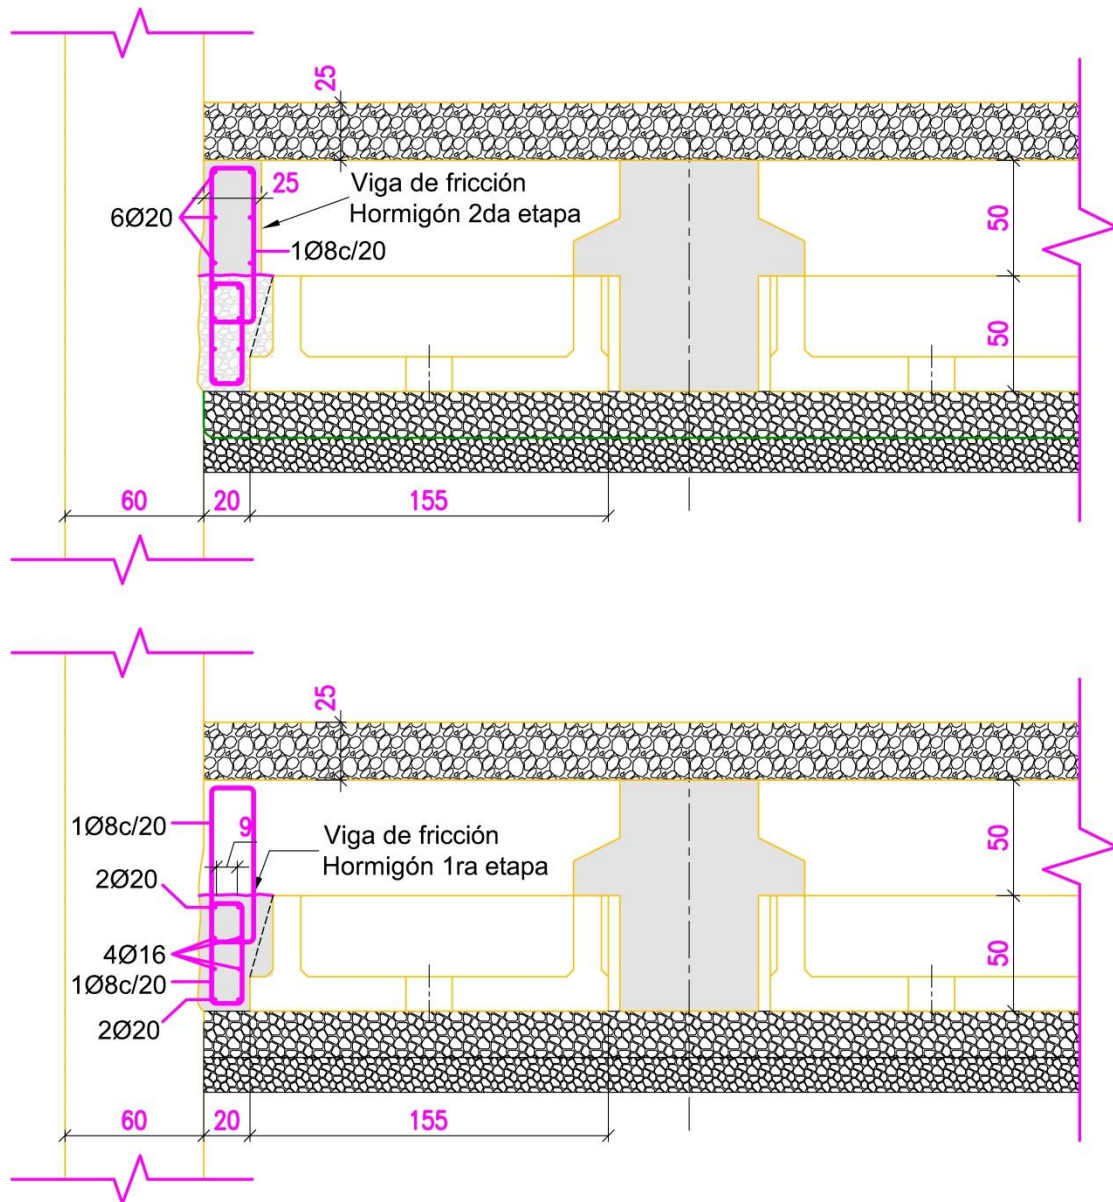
Detalle de la viga de fricción, primera y segunda etapa
